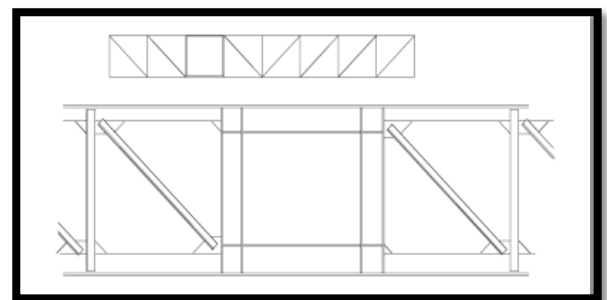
Les poutres échelles ou poutres Vierendeel¹⁶⁵
